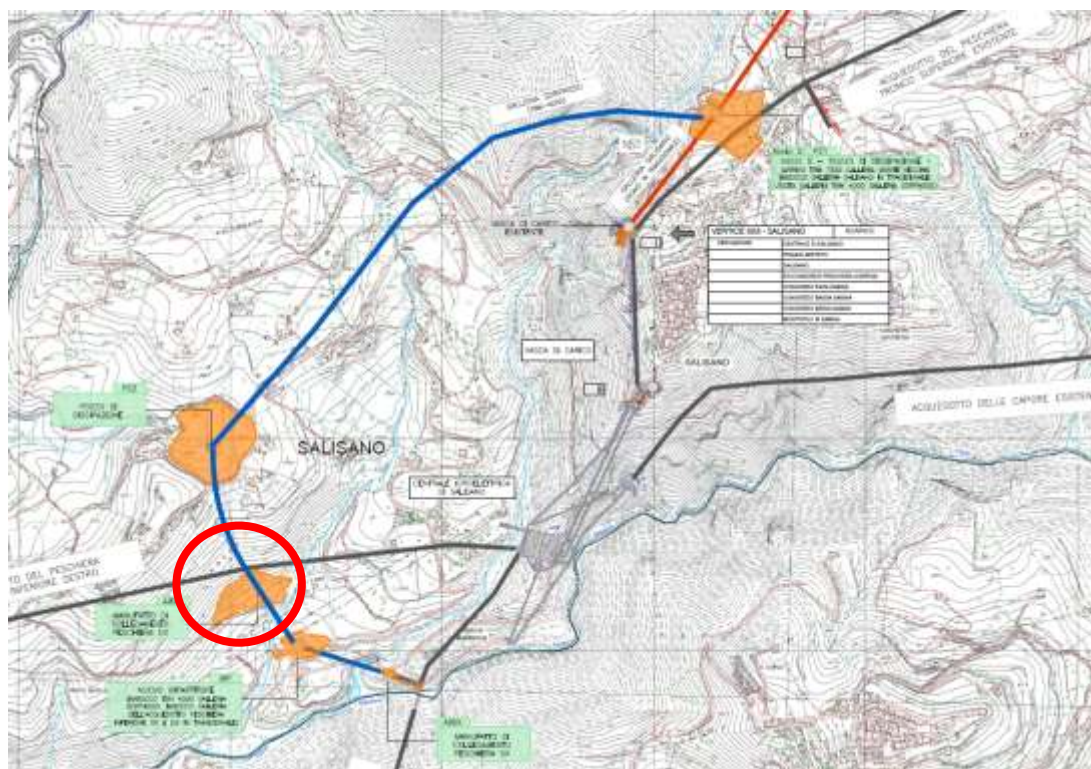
Ubicazione dei Manufatti di Collegamento al Peschiera Destro (PiDX)
